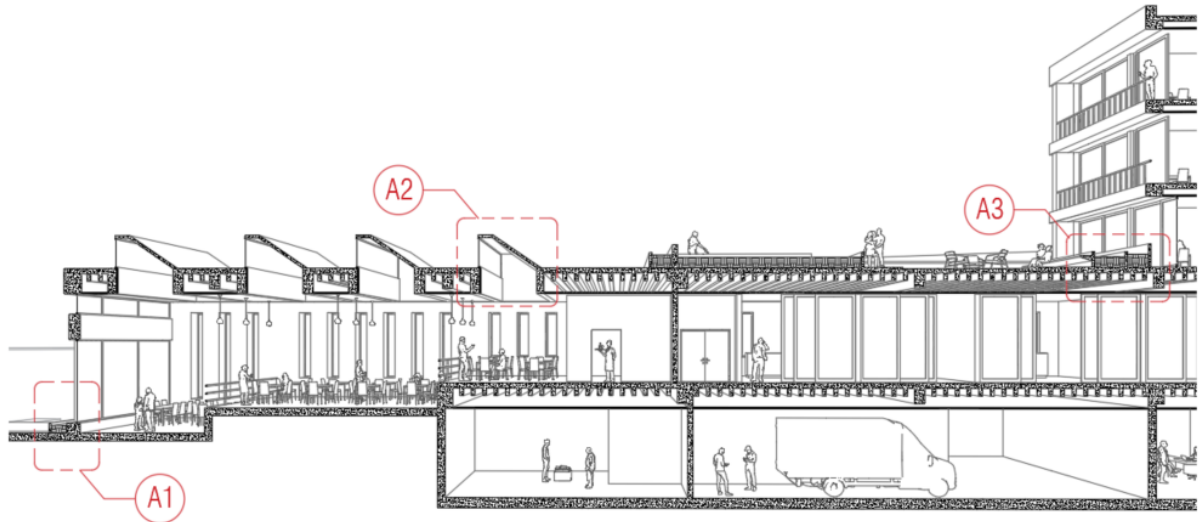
Sección fugada - Proyecto definitivo. Elaboración propia.
